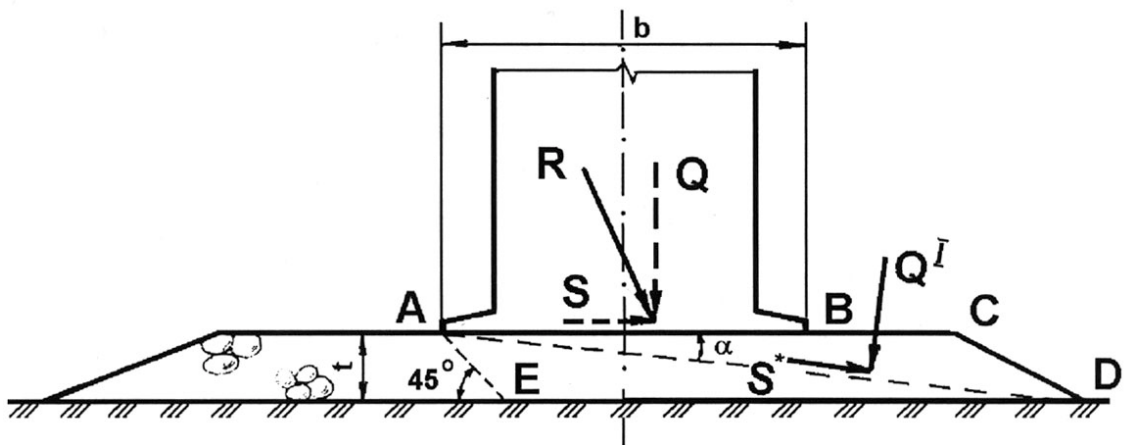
Расчетная схема к определению устойчивости сооружения на плоский сдвиг
